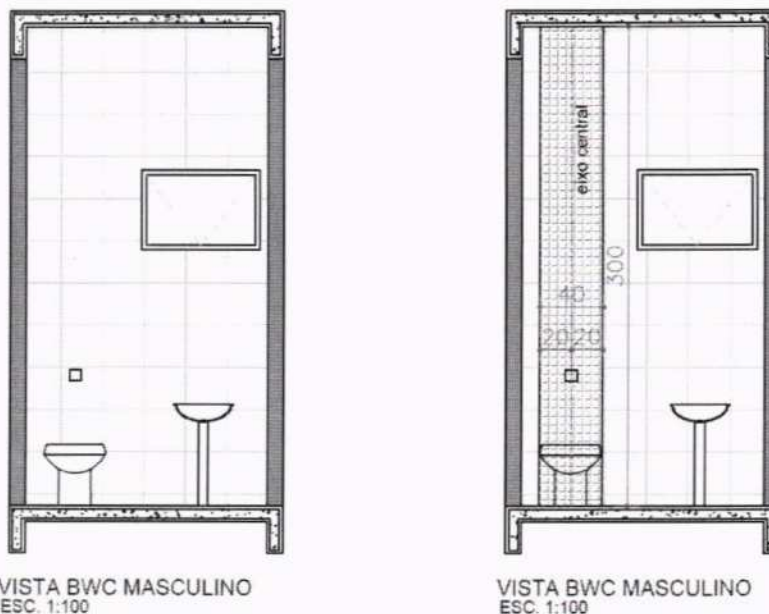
Planta baixa localização da troca de revestimento cerâmico de paredes
